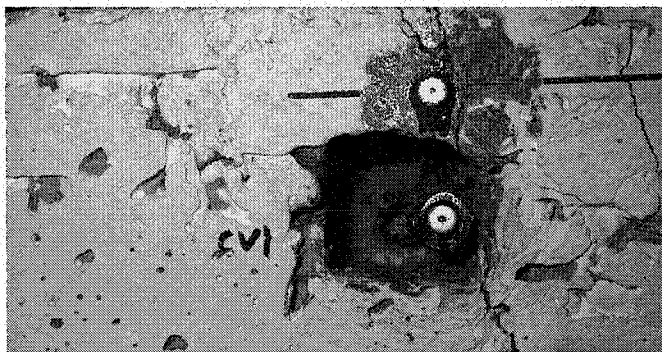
Point DEMEC installé sur l'extrémité de la barre
